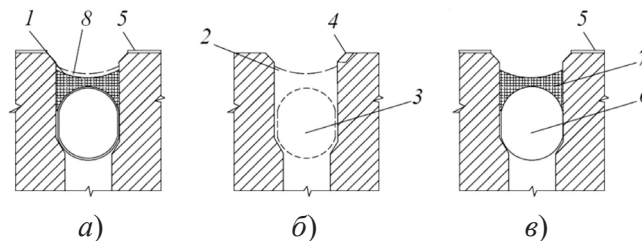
Ремонт швов наружных стеновых панелей: *a* – нанесение дополнительного слоя герметика; *б* – разборка гидроизоляции и герметика; *в* – укладка уплотняющей прокладки и герметика; 1 – очистка поверхности; 2 – разборка герметика; 3 – снятие уплотняющей прокладки; 4 – ремонт граней; 5 – наклейка малярной ленты; 6 – установка уплотняющей прокладки; 7 – нанесение герметизирующей мастики; 8 – нанесение дополнительного слоя герметизирующей мастики
